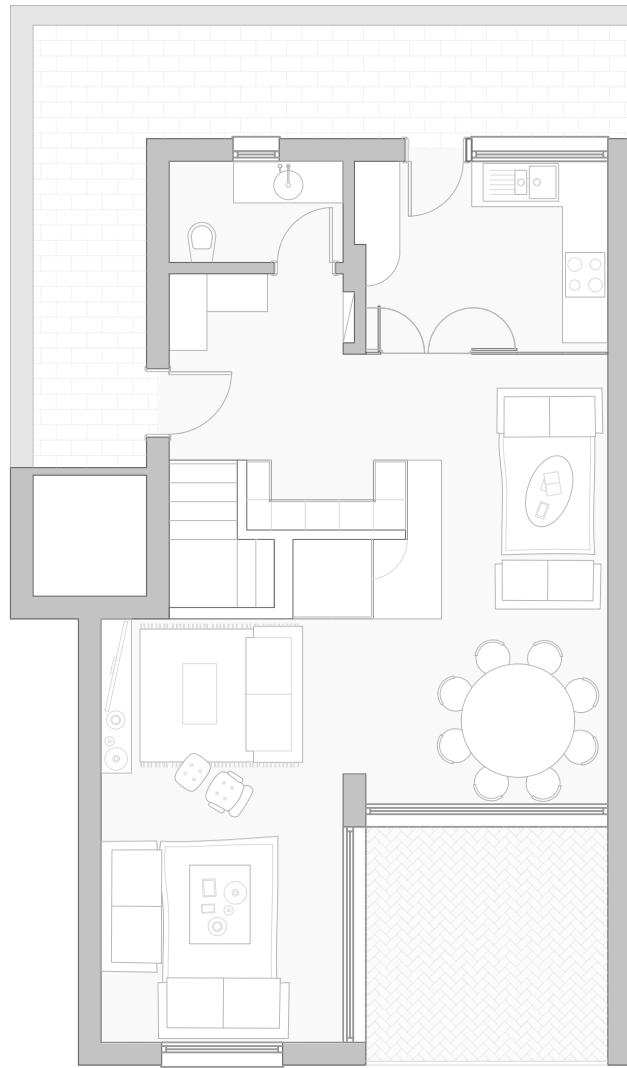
Planta T3 2x1 Piso Inferior 1:100
